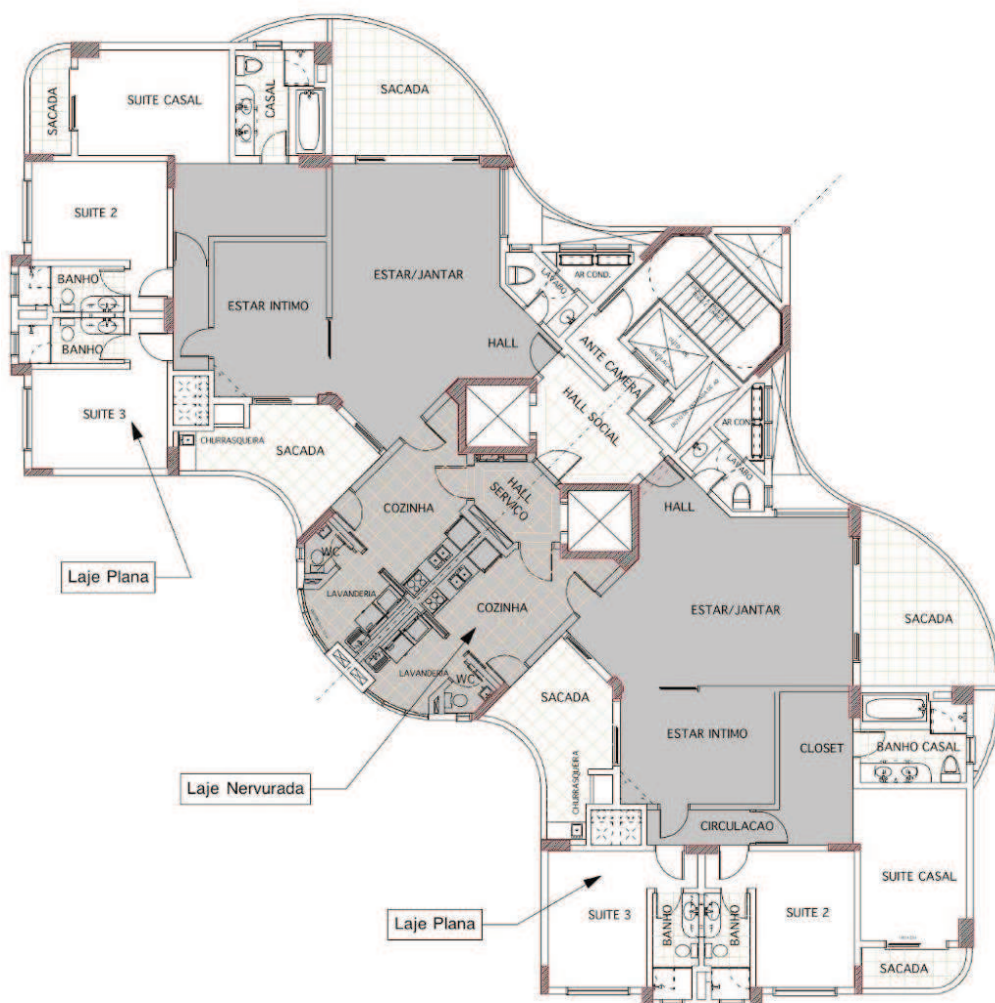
Planta Baixa do Pavimento Tipo (Lajes) - sem escala.
